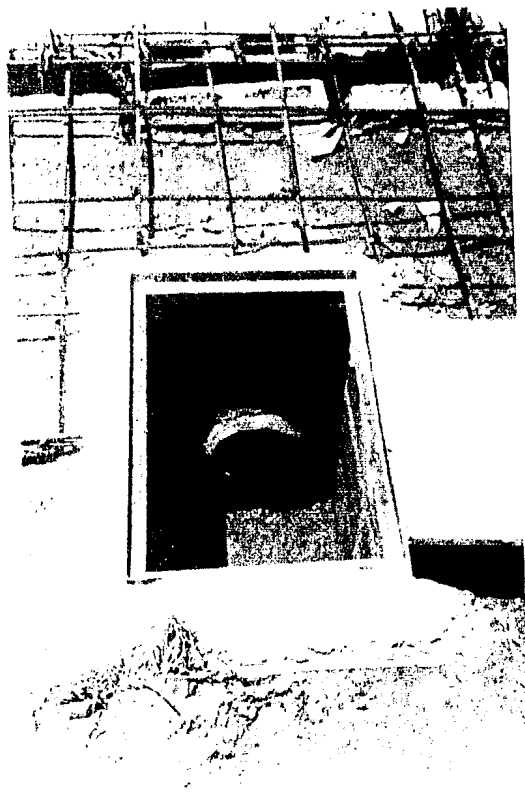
Preparación de registro para -- instalación sanitaria antes de colar losa de cimentación.
